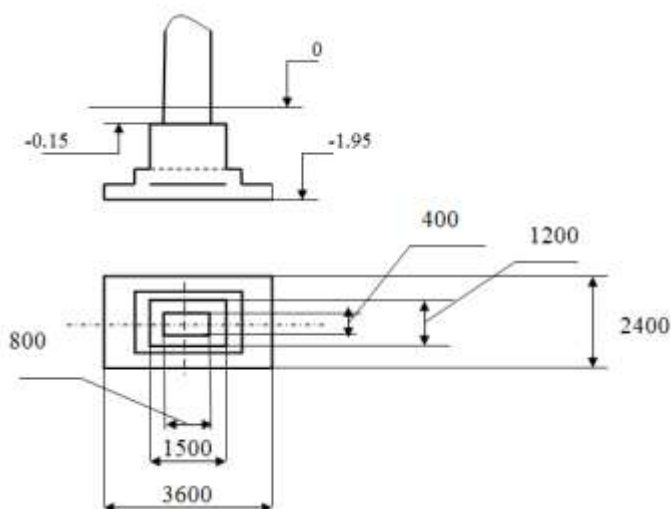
Фундамент под колонны серии КЭ-01-49
